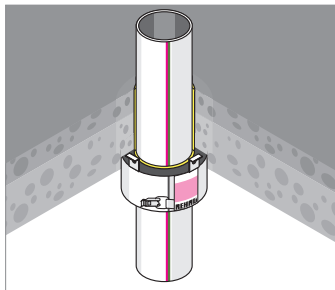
Монтаж противопожарной манжеты в перекрытие
